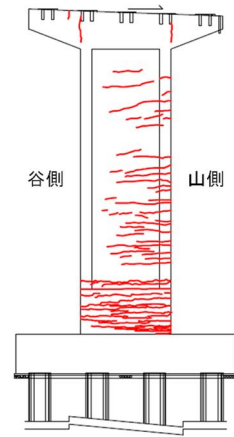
P2 橋脚起点側のひび割れ図
